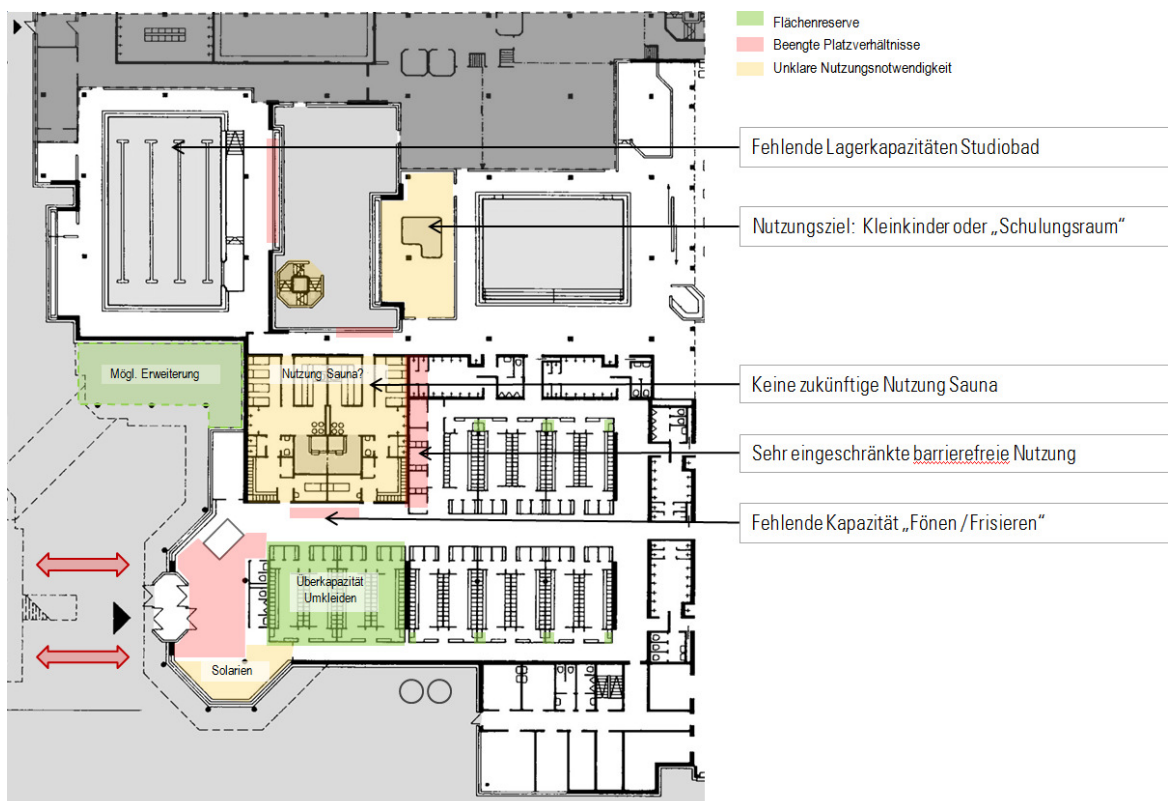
Grundrißbetrachtung: „Funktionen“ Teil 2 (Umkleiden, Studiobecken, Kleinkinderbecken)
